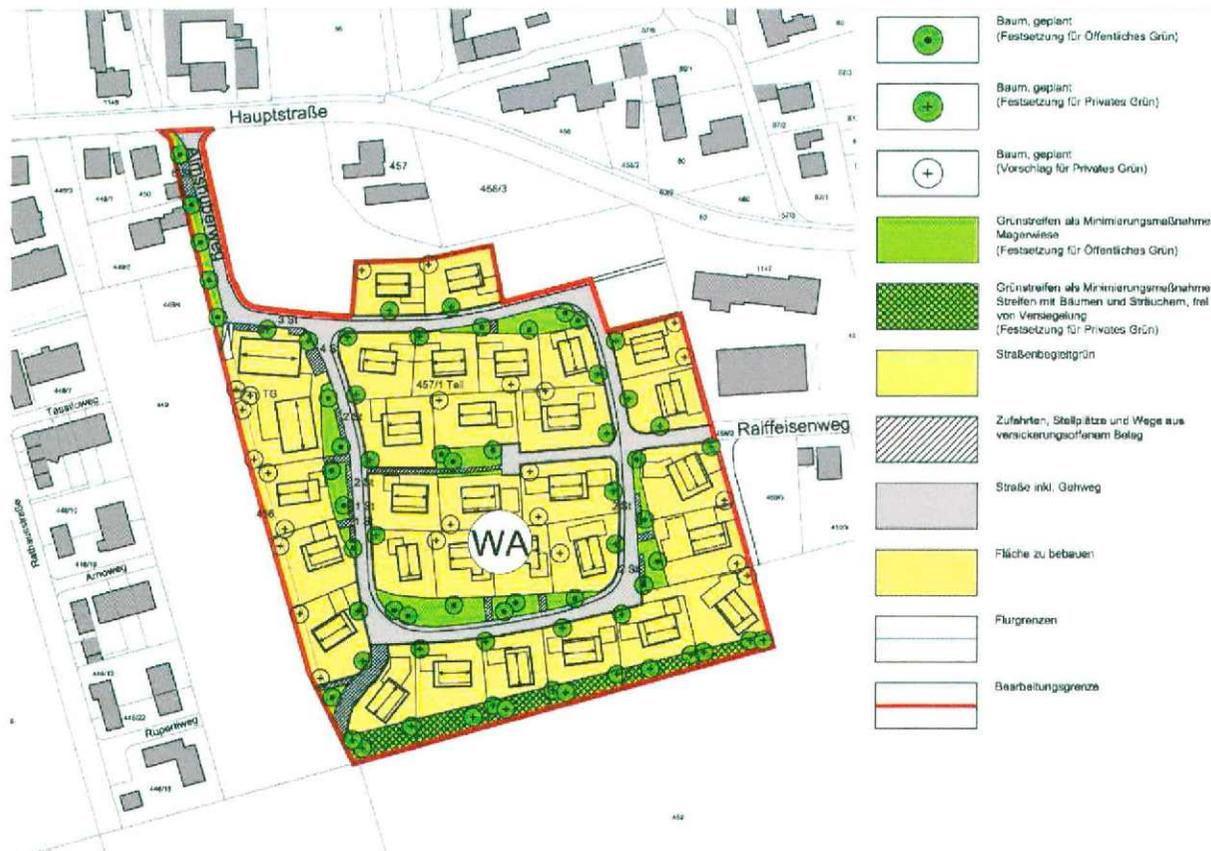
Bebauungsplan „Sonnenfeld“ Abschnitt 2 - WA
